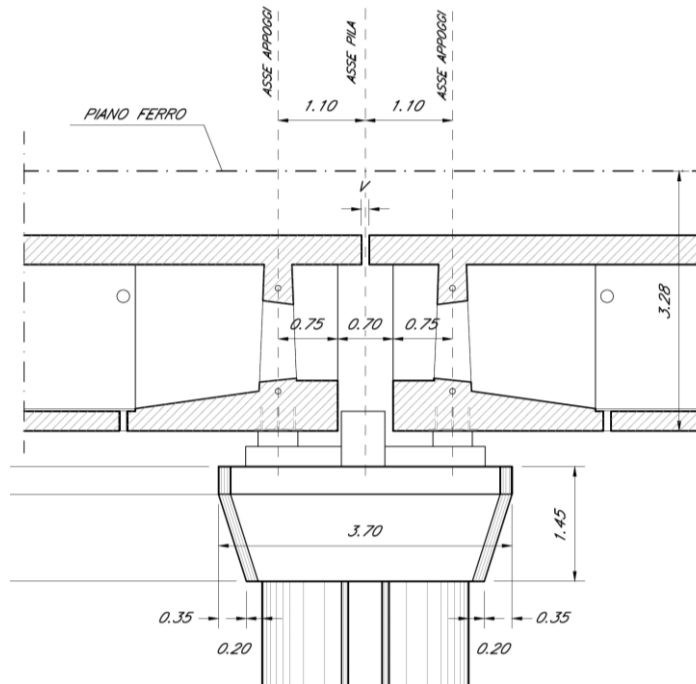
Pila, prospetto longitudinale – Due impalcati CAP
